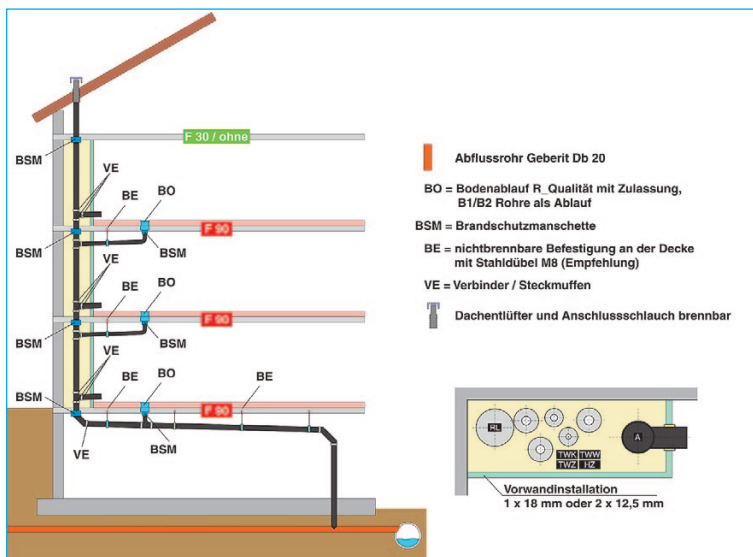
Offenes Entwässerungssystem mit brennbaren Rohren. Werden ausschließlich brennbare Abflussrohre in Verbindung mit R 30- bis R 90- Rohrabschottungen / Brandschutzmanschetten montiert, wird die Abschottung im Brandfall durch den Verschluss der Durchführungen erreicht. Eine optimale Lösung ist die Montage der Leitungsanlagen inkl. Raumentlüftung, Versorgungsleitungen (brennbar / nichtbrennbar), Elektro hinter einer Vorwandinstallation.
